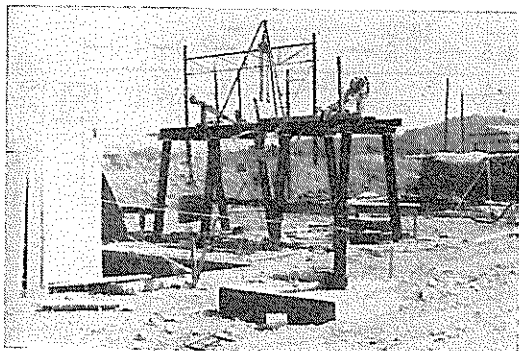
載荷台 (Pile No. 3 および Pile No. 6 載荷時)
